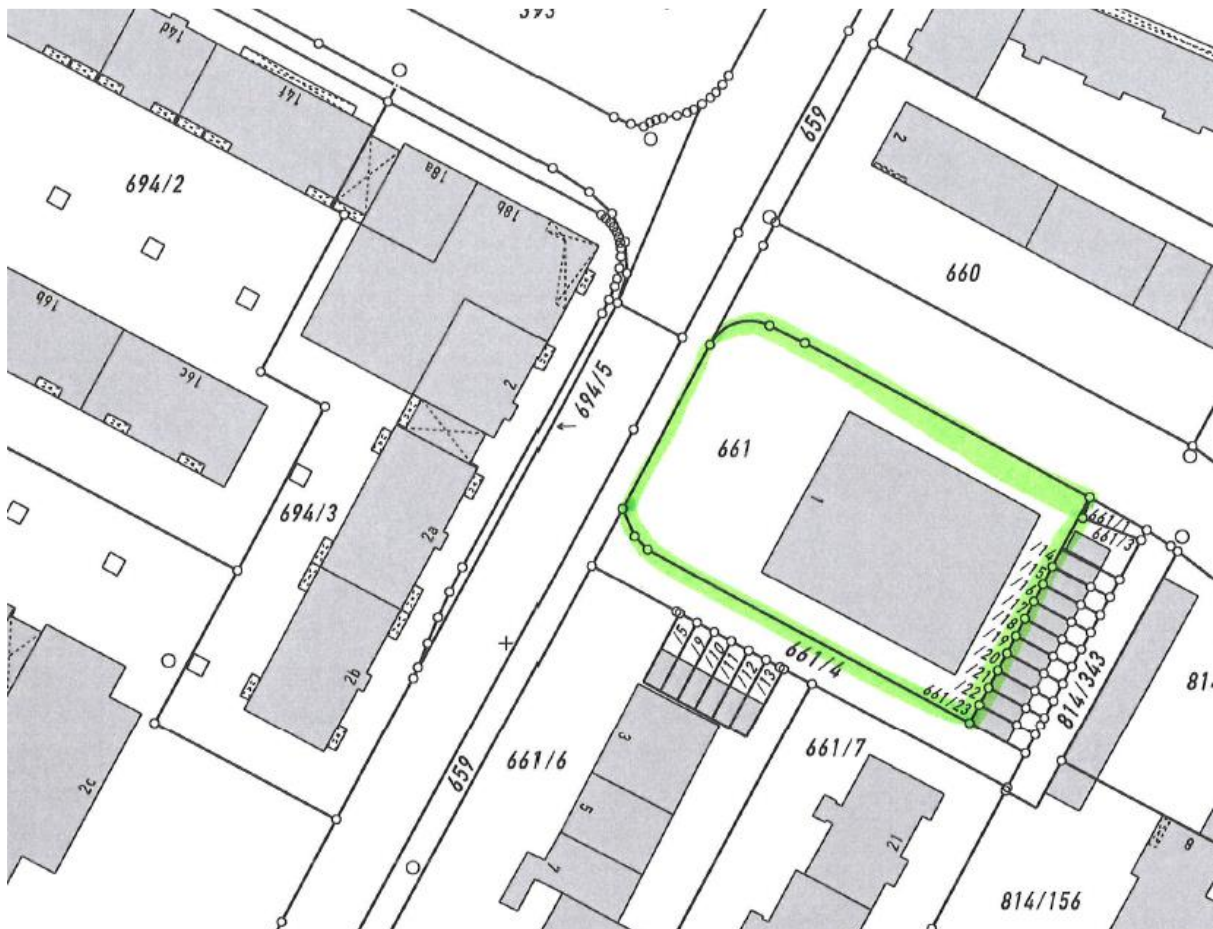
Lageplan und Untersuchungsbereich (grün)
